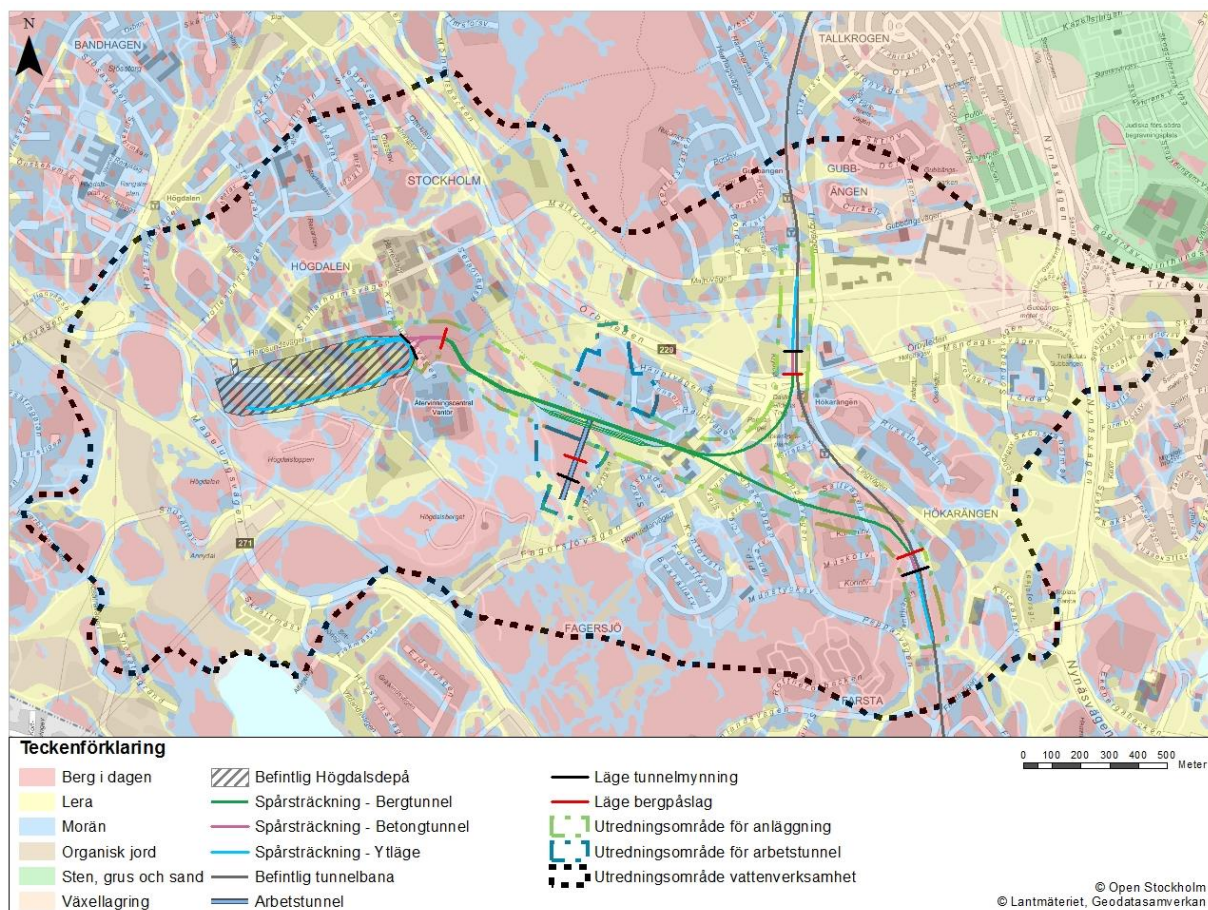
Tunnelbyggande och påverkan på grundvatten.
